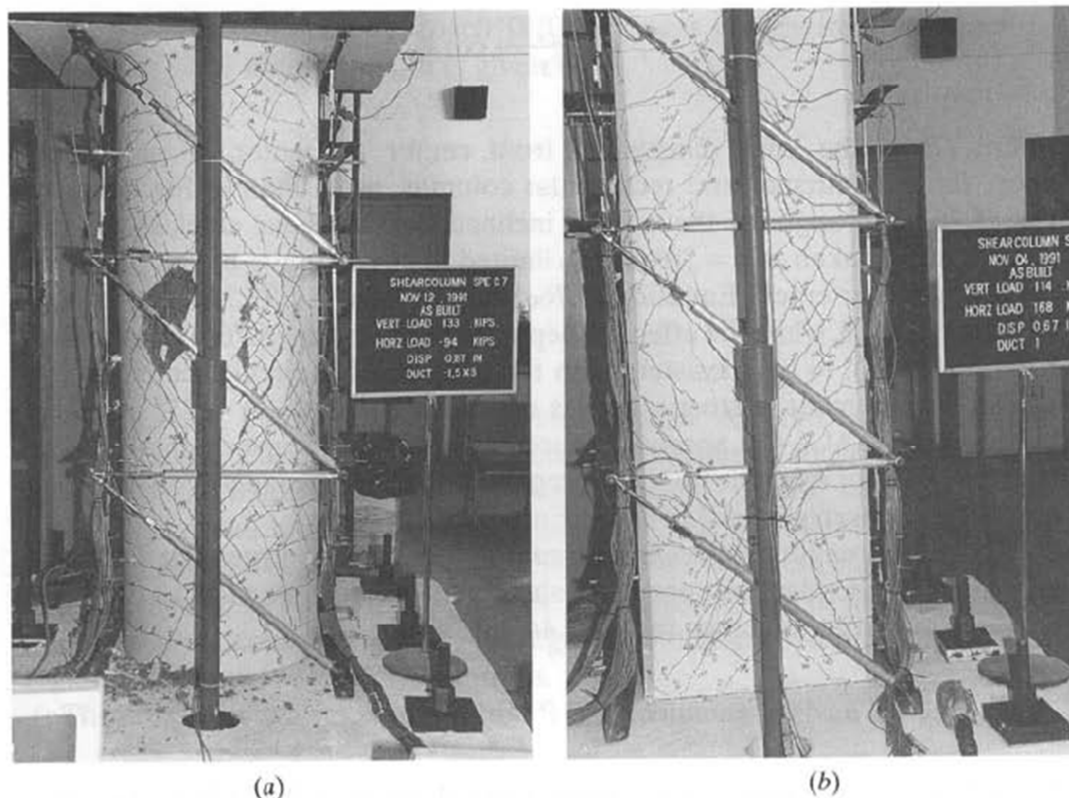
Fisuras inclinadas debido a flexión-cortante en columnas sujetas a ciclos invertidos de deformación. (a) Columna circular; (b) Columna rectangular. (Tomado de Priestley, Seible y Calvi, 1996)
